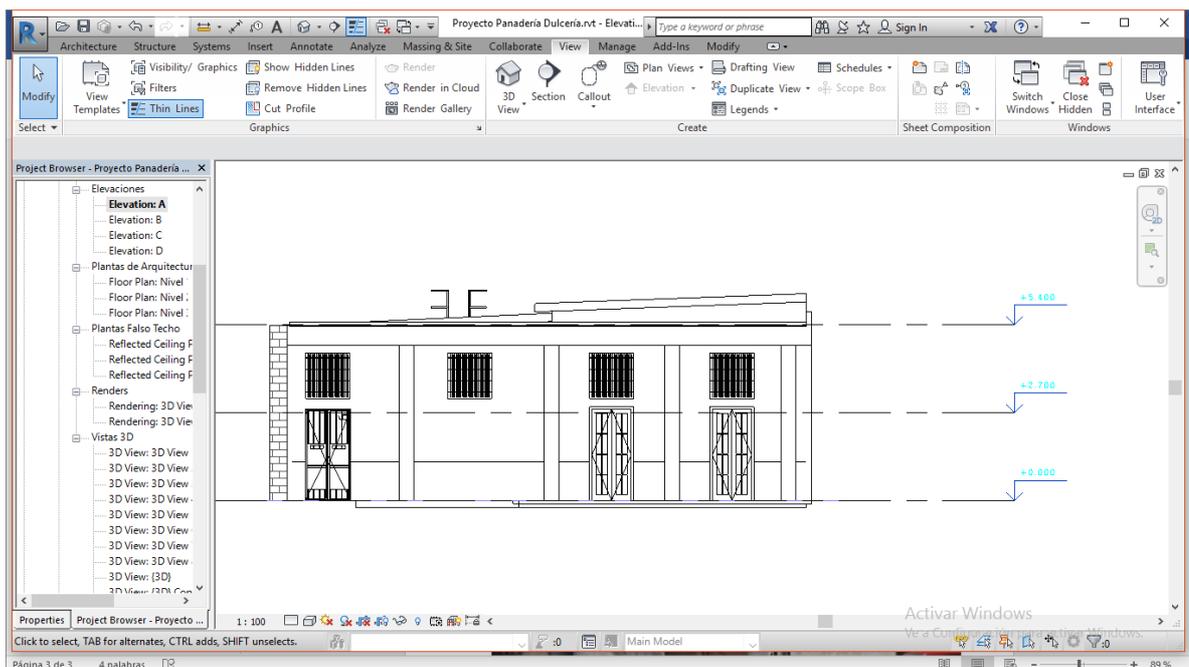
Vista de los niveles de la parte frontal del edificio. Fuente: Proyecto “Panadería Dulcería “Empresa IDEAR de Cienfuegos.
